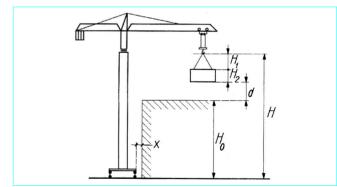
Survol d'un bâtiment ou d'un ouvrage
